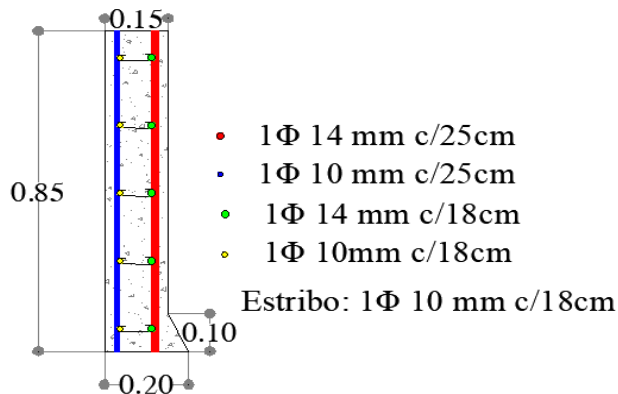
Armado en sentido longitudinal y transversal de la protección lateral de hormigón armado (maciza)
